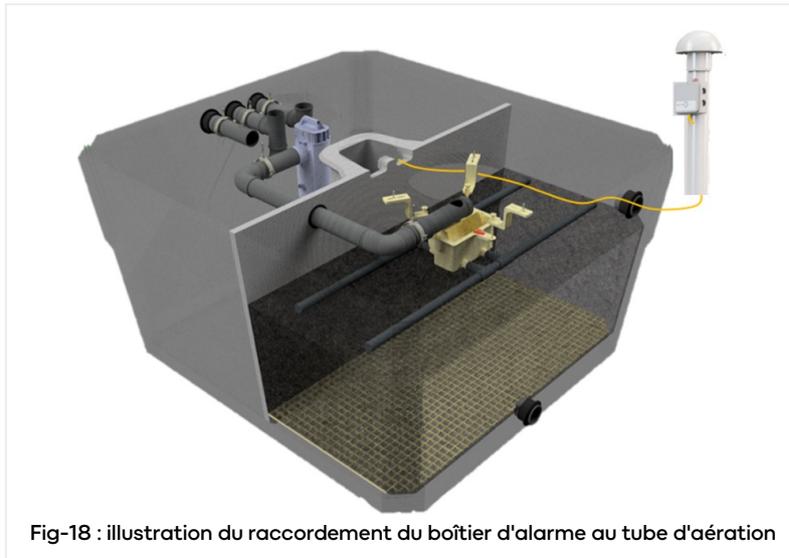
illustration du raccordement du boîtier d'alarme au tube d'aération
